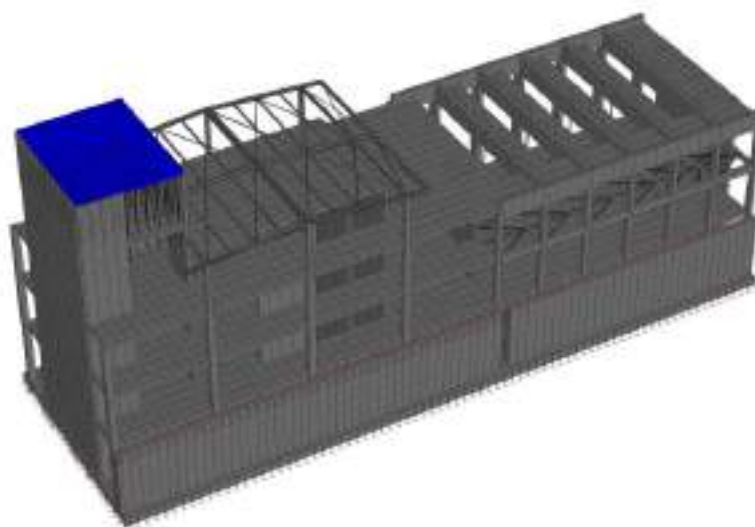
implementazione del carico pacchetto pavimentazione L4 – $g_k = 3.60 \text{ kPa}$.
